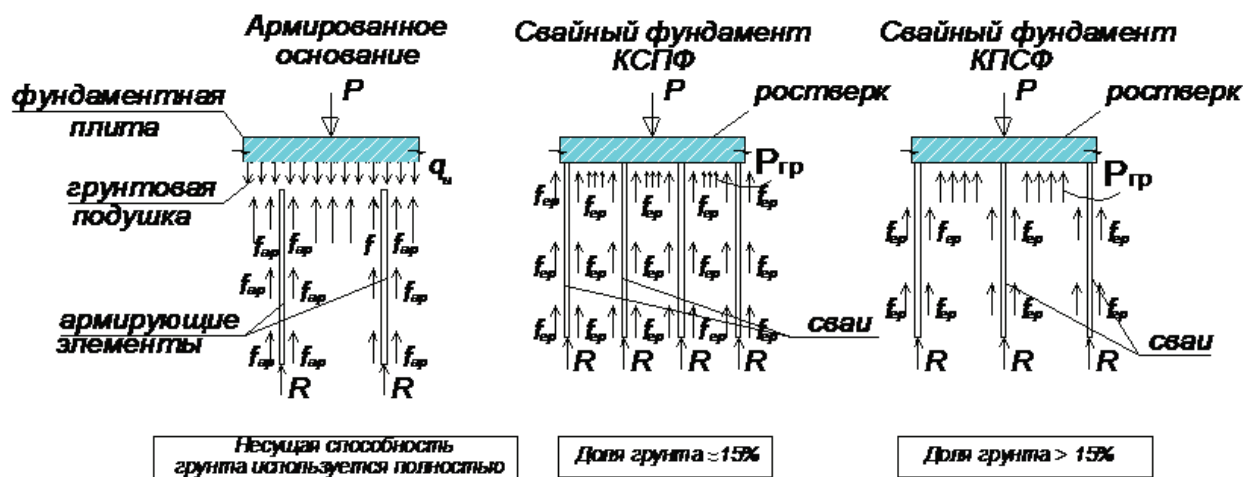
Схемы передачи нагрузки на армированное вертикальными элементами грунтовое основание, свайное основание типа КСПФ (комбинированный свайно-плитный фундамент) и КПСФ (комбинированный плитно-свайный фундамент)
